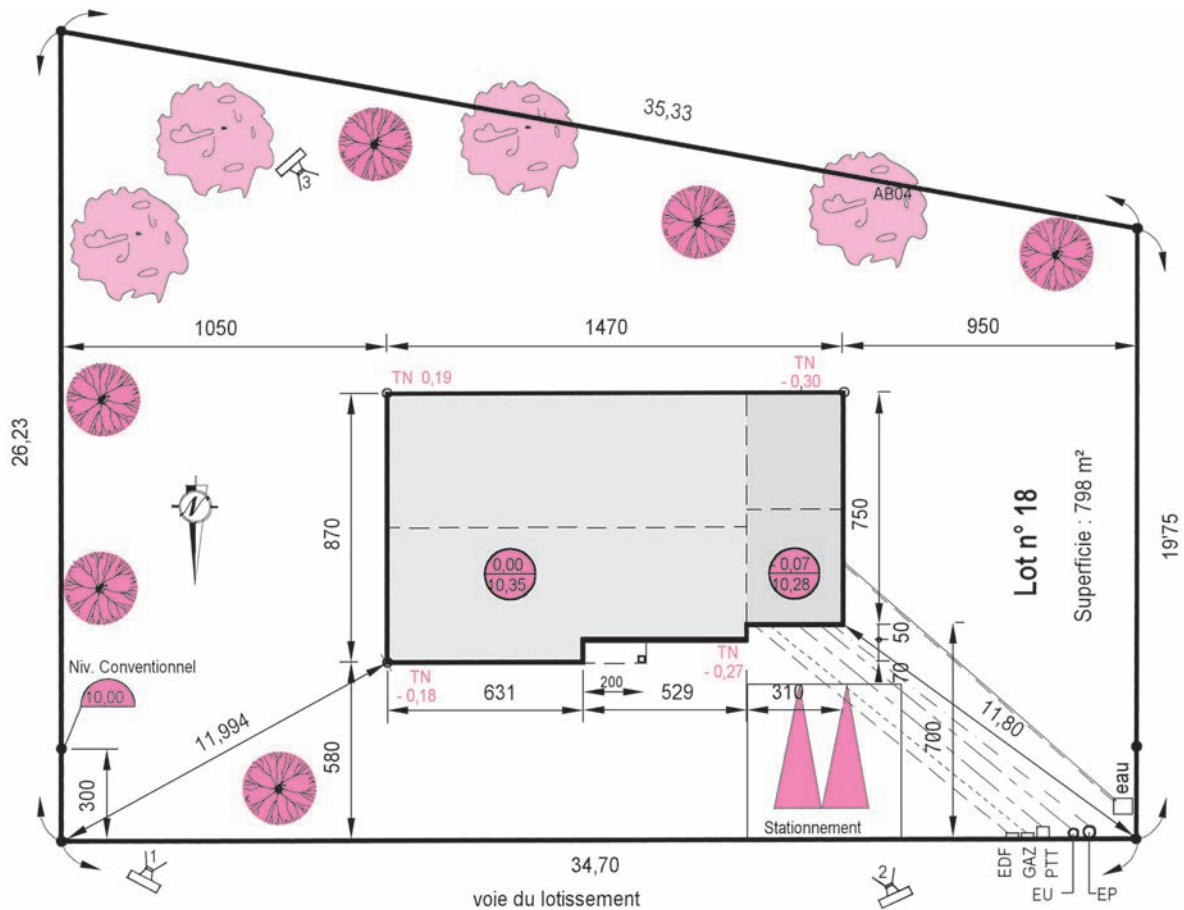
Plan de masse avec position des boîtes de branchement EU et EP
